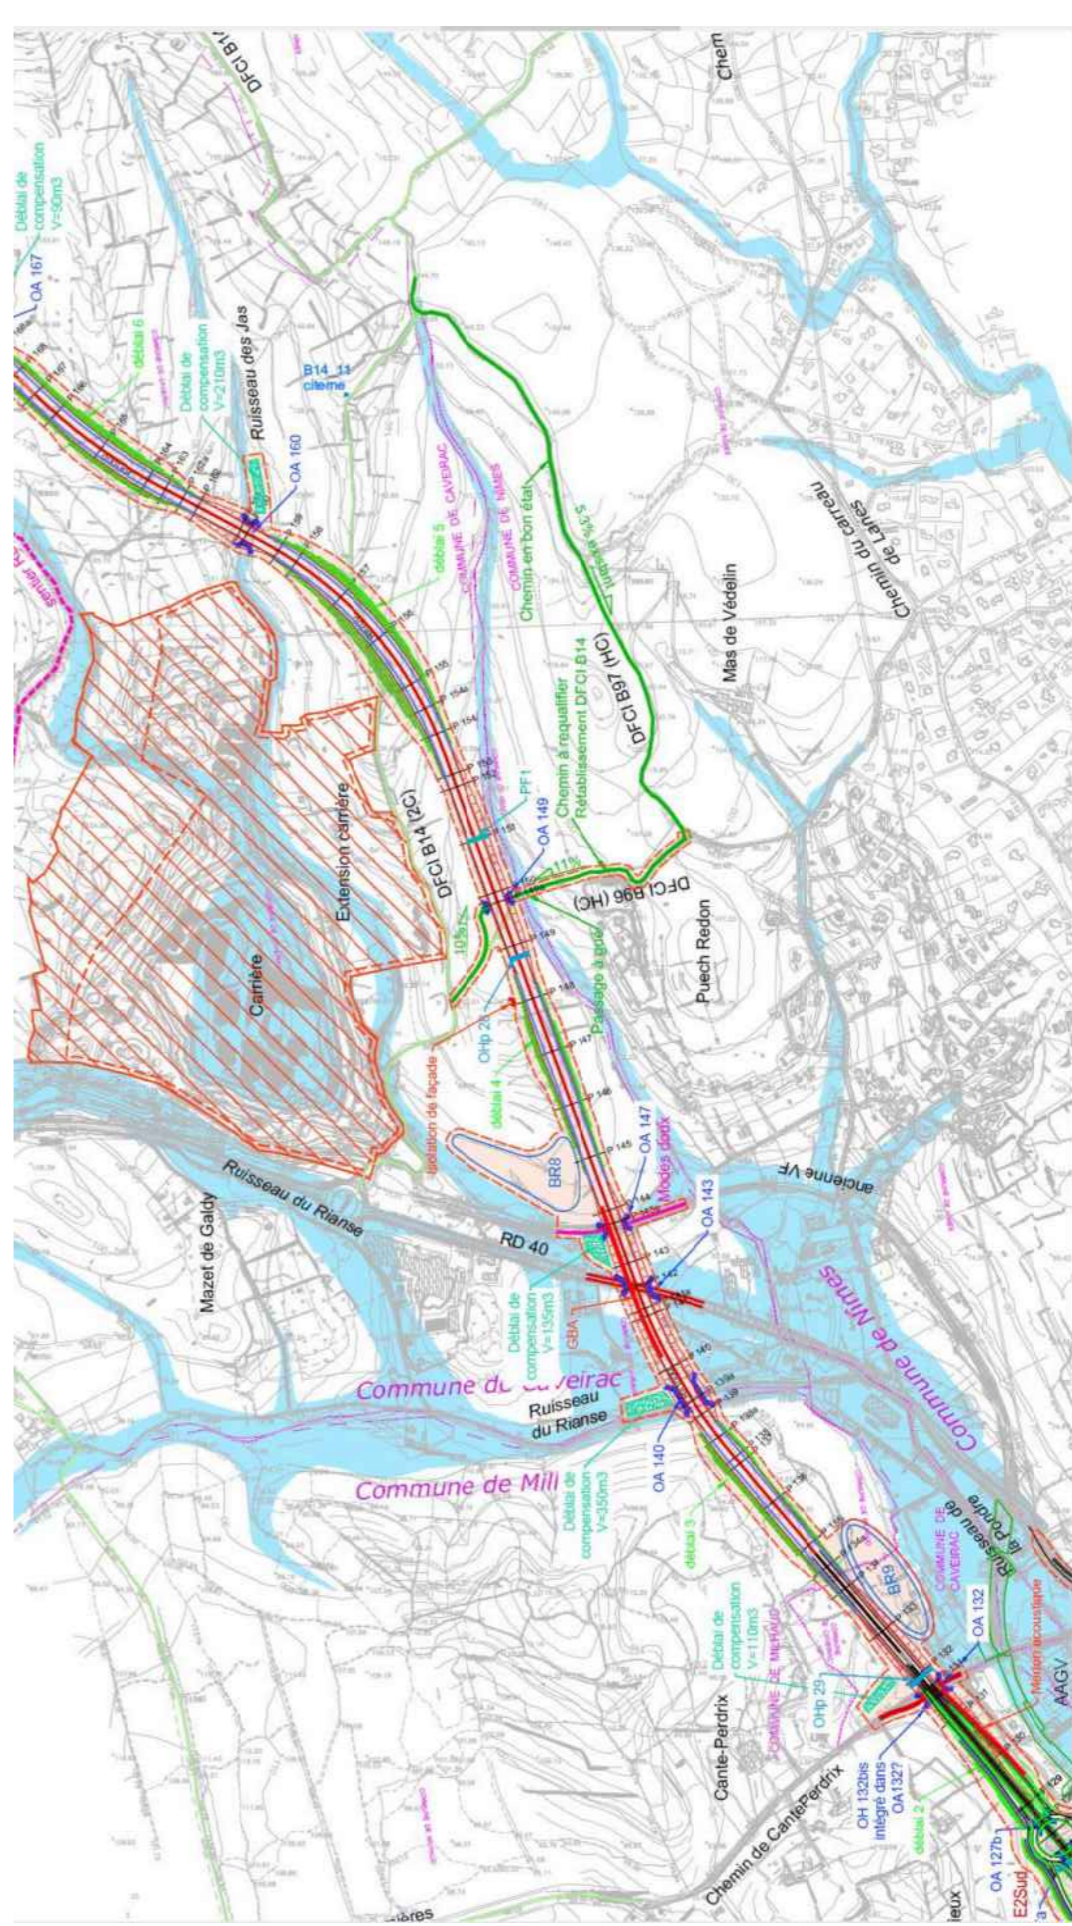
Plan de masse du projet (Source : Présents, Juin 2021)
